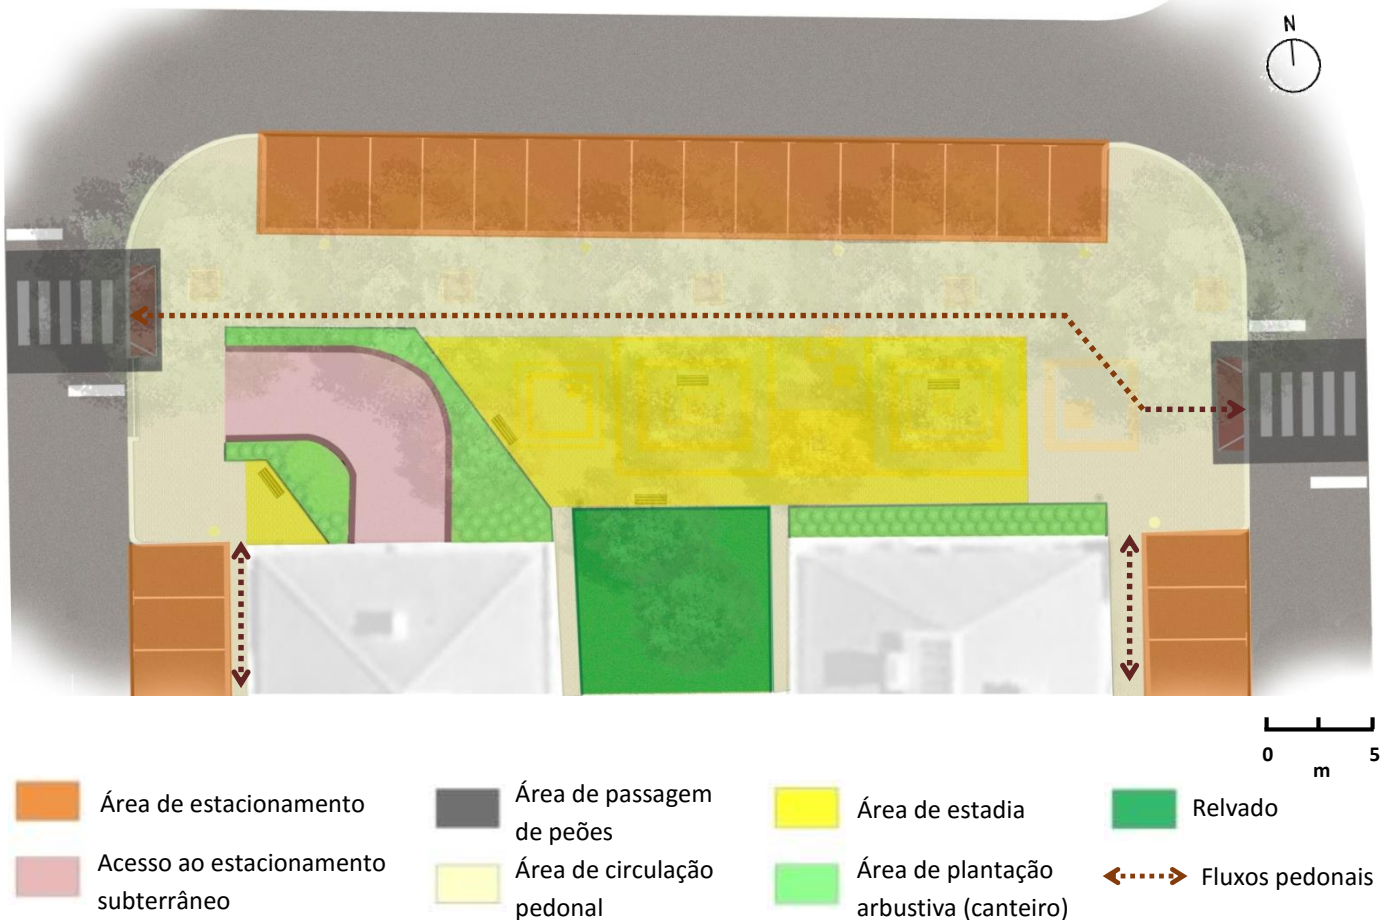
Planta de zonamento funcional proposto para a praça (Fonte: autora do trabalho)
